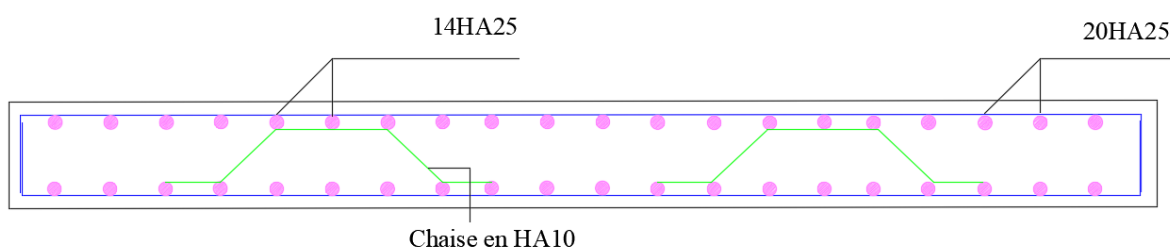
Schéma de ferrailage de la dalle de radier.
